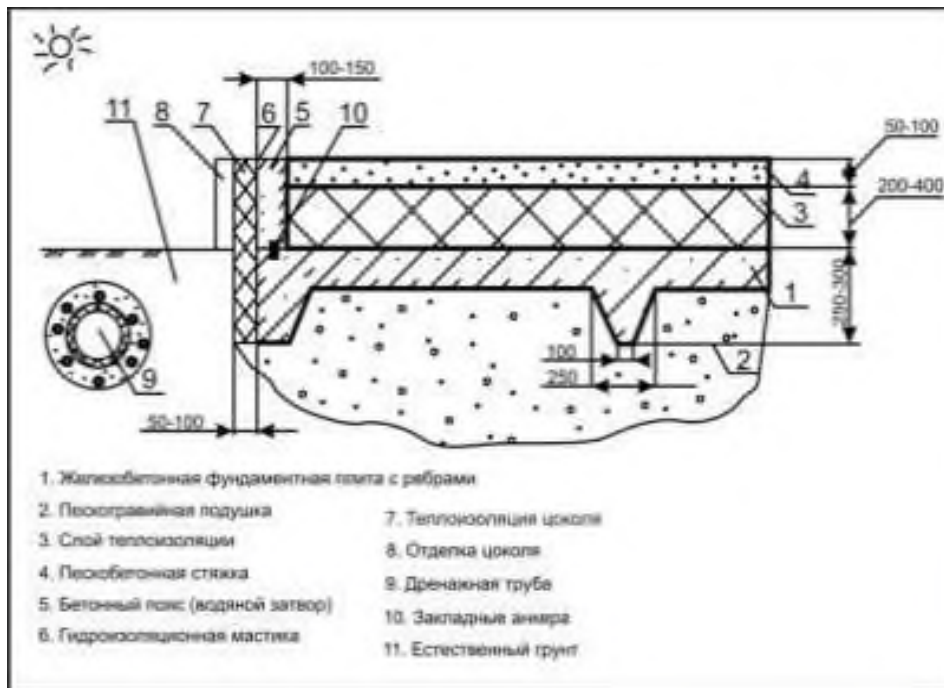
Залізобетонний фундамент у вигляді плити
